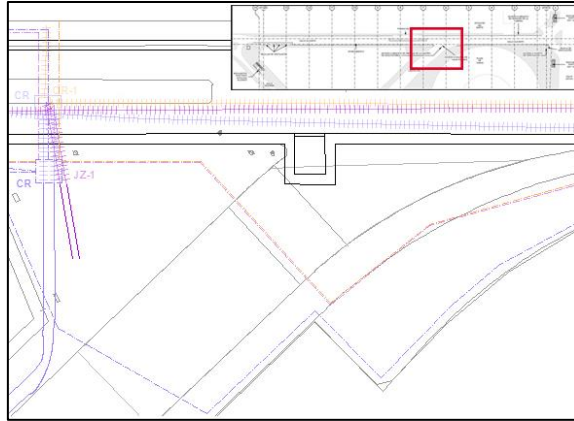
Plano de desvío TEF-TLF1; JZ1; OR1-RP-CX-F5. Zona central
